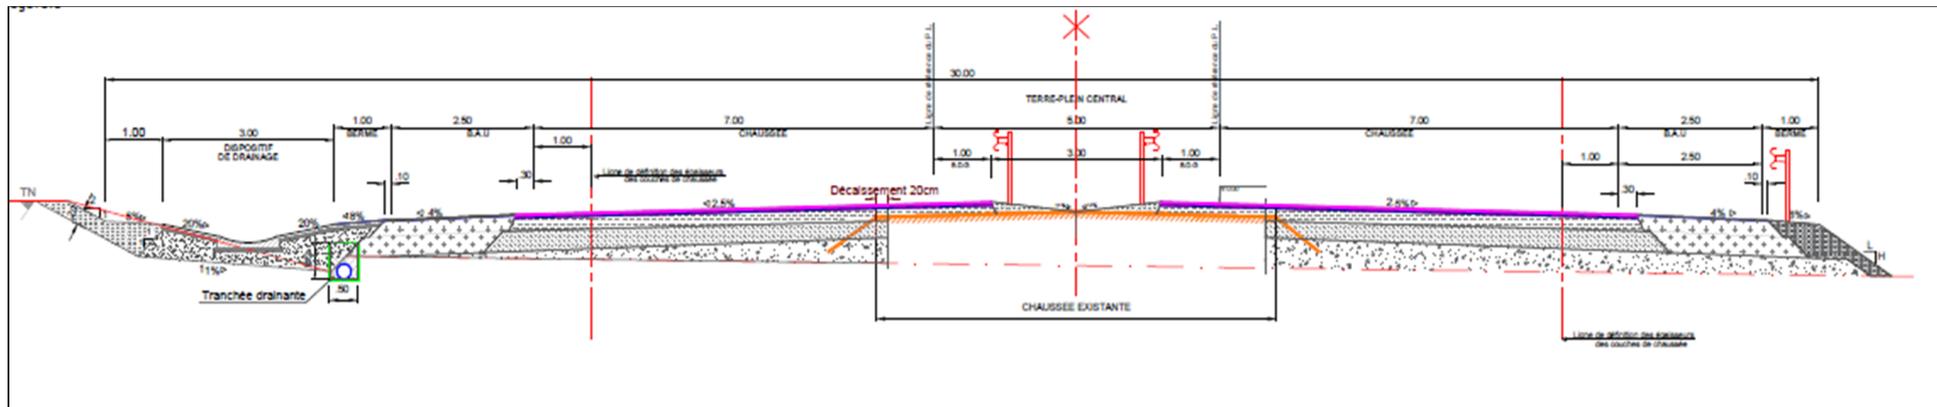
Profil en travers type dans le cas d'élargissement de chaussée existante Bilatérale
